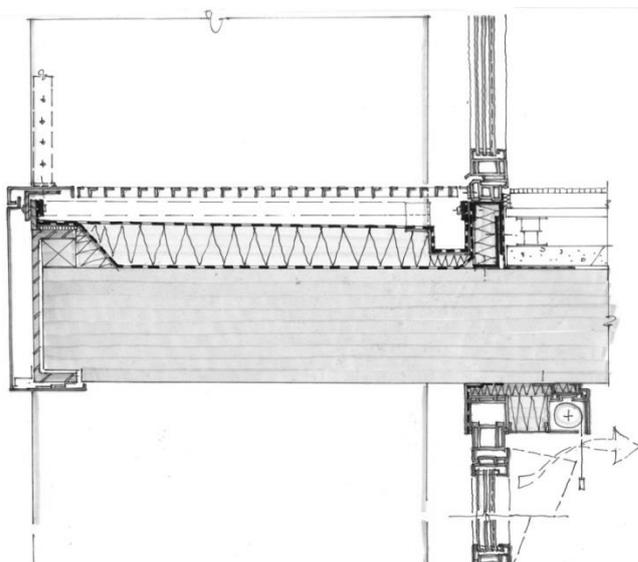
Darstellung der Holzdecke anhand eines Details
